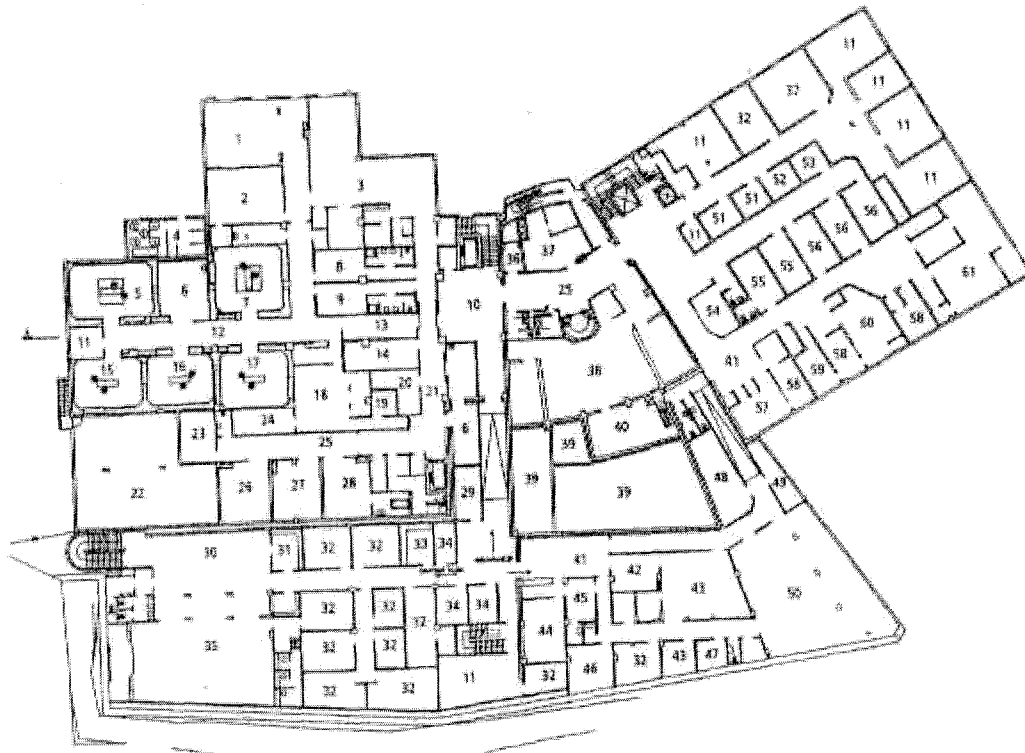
Acıbadem Hastanesi Kadıköy vaziyet planı
